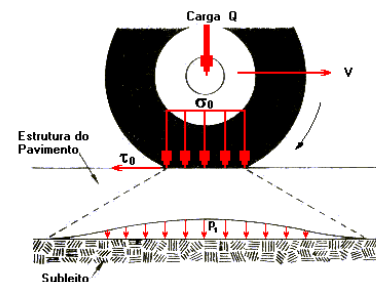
Cargas no Pavimento (SANTANA, 1993)
